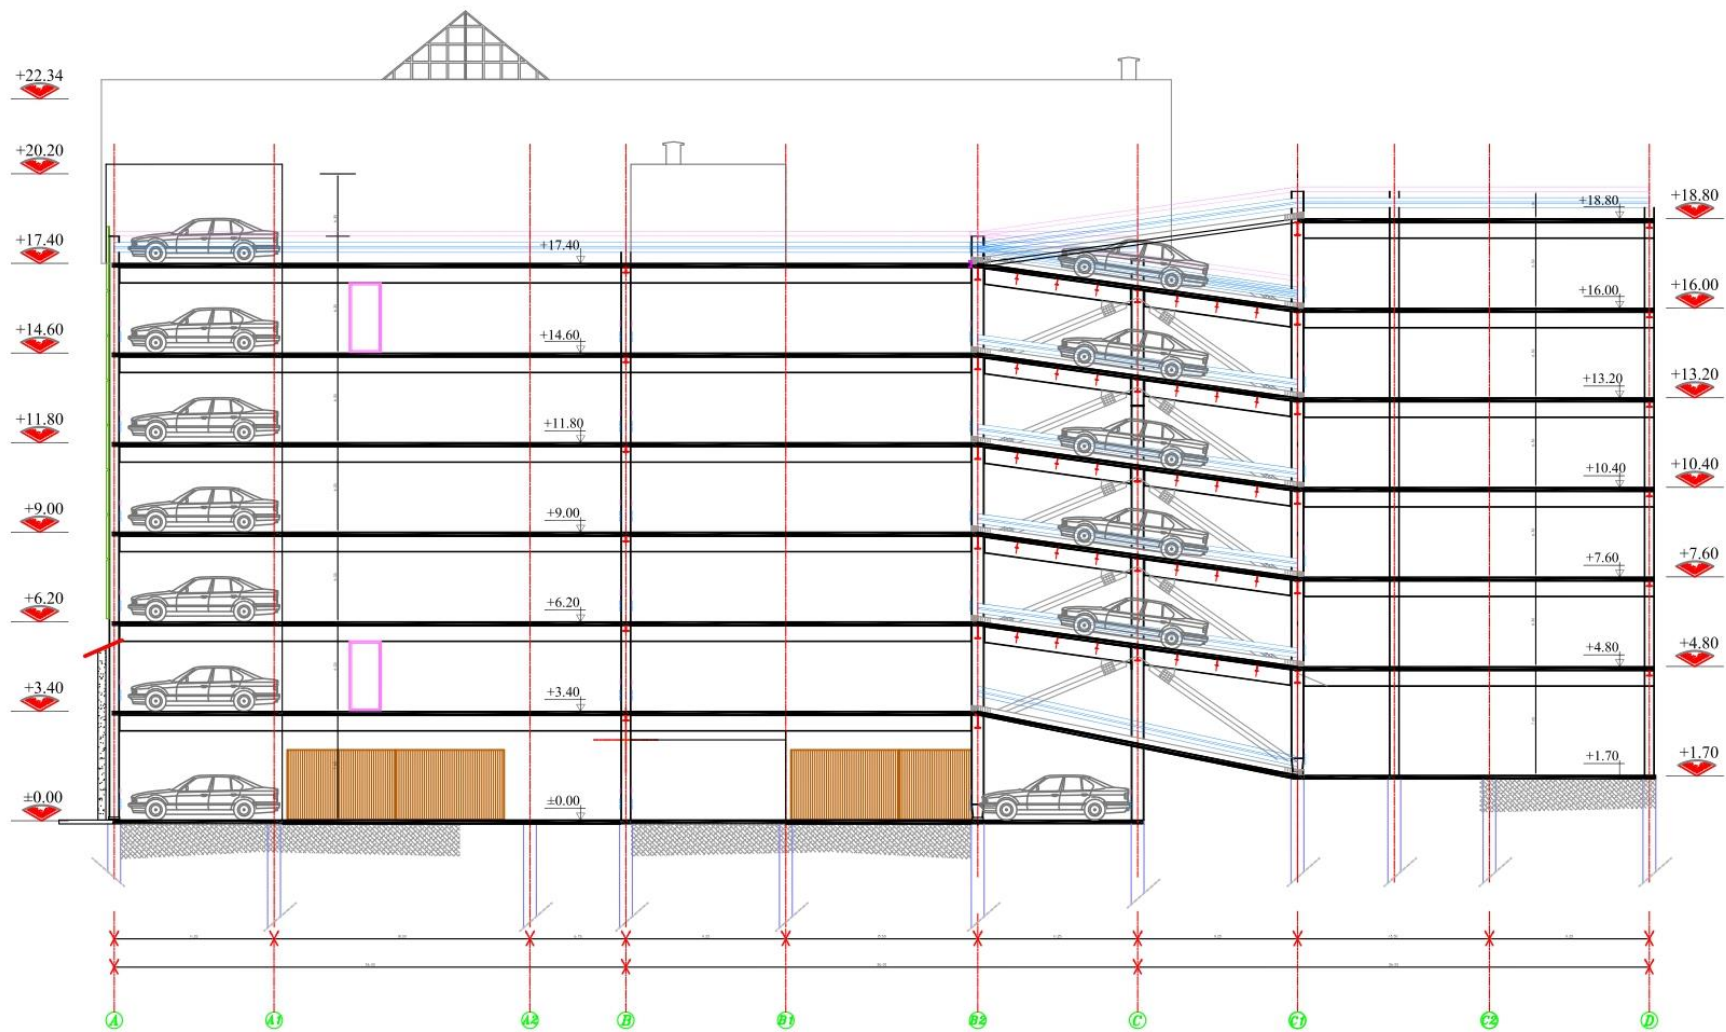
Plan d'architecture (Coupe A-A) [Autodesk AutoCAD 2023]
